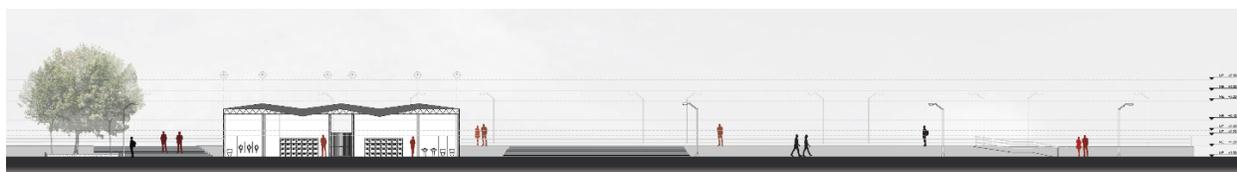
Sección Corte - perfil B-B'; Fuente: Elaboración propia
